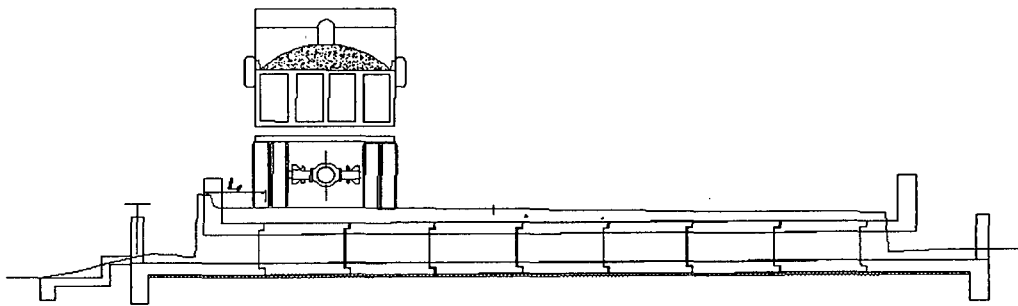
Vista en elevación del camión para la prueba de junta con carga en borde lateral
